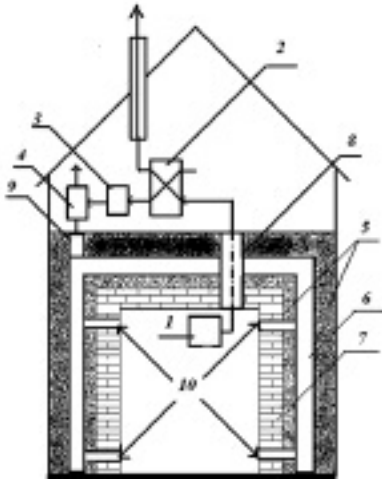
Схема вентиляции здания с вентилируемой прослойкой
